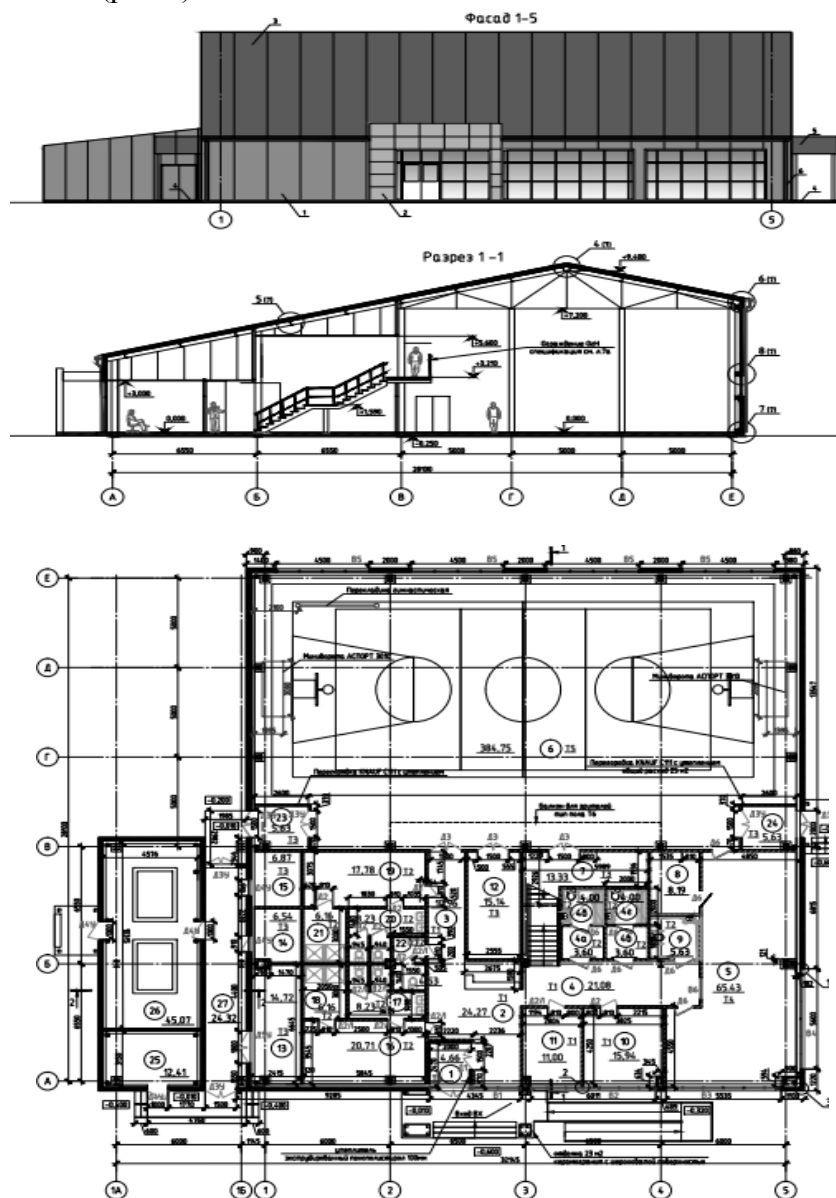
Фасад 1-5, Разрез 1-1, план на отм.0,000
